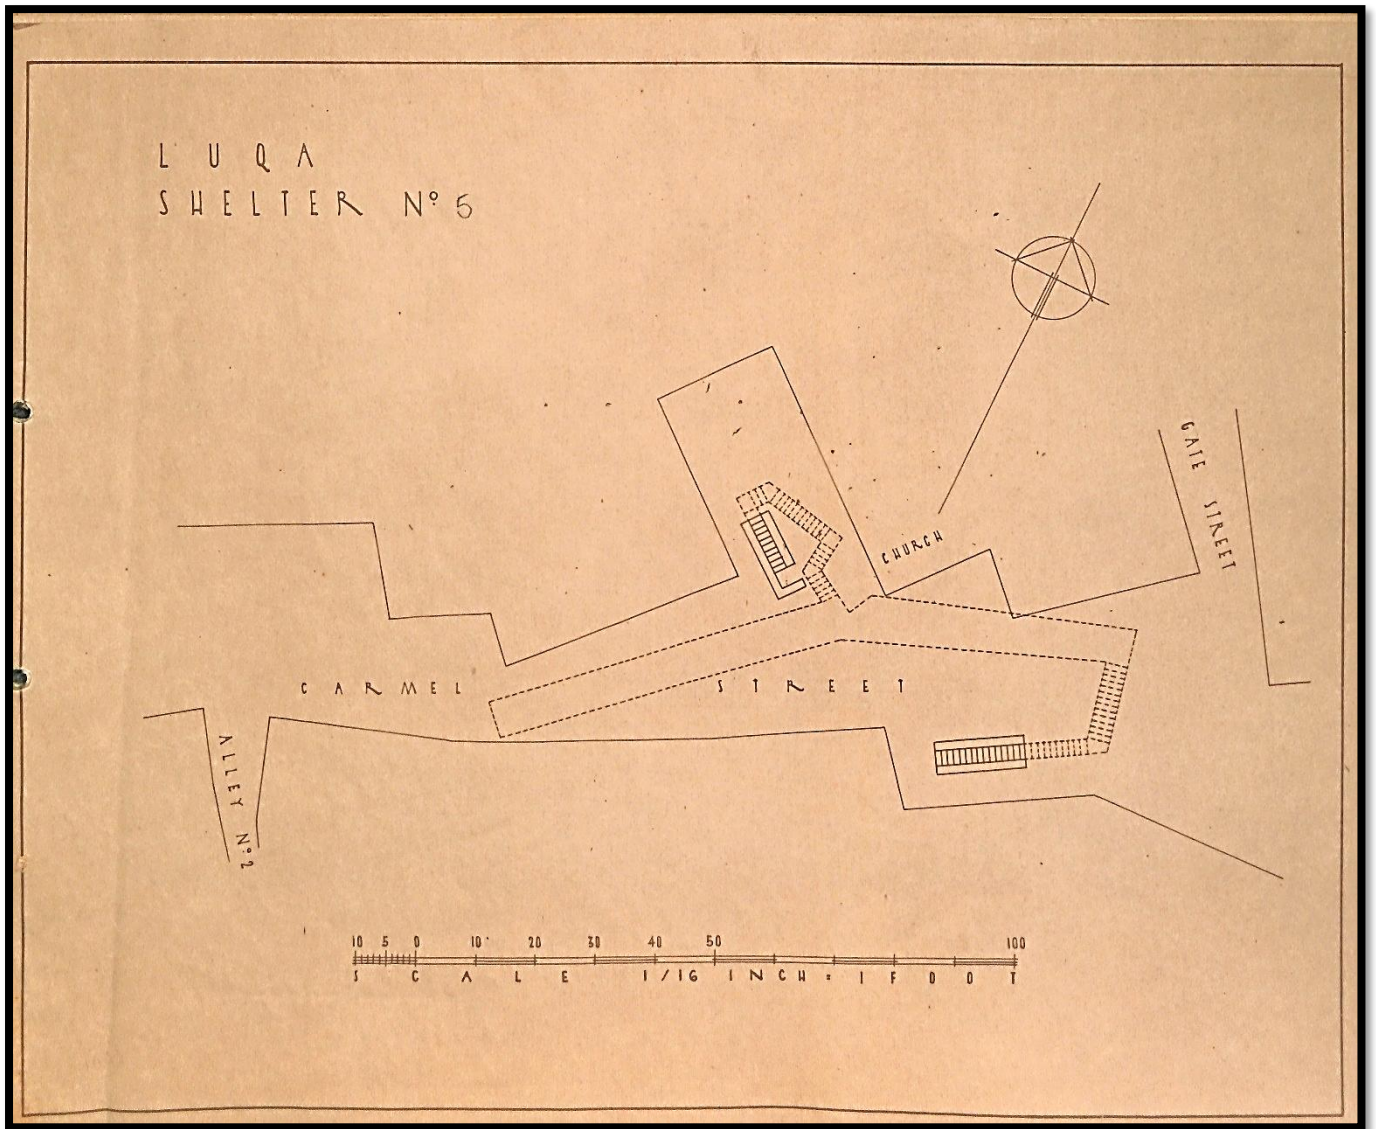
Planta do Abrigo nº5 "Carmel Street – Gate Street – Alley nº1"
